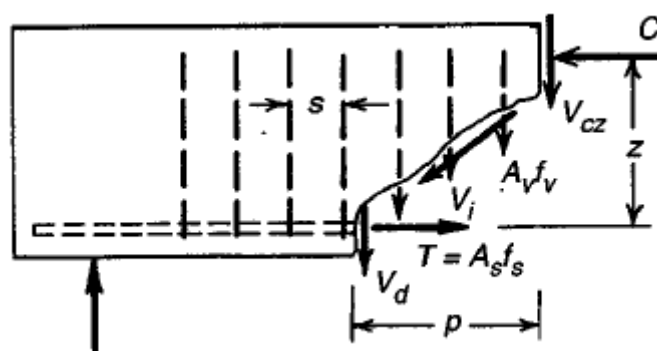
Fuerzas en una grieta diagonal de una viga con estribos verticales
